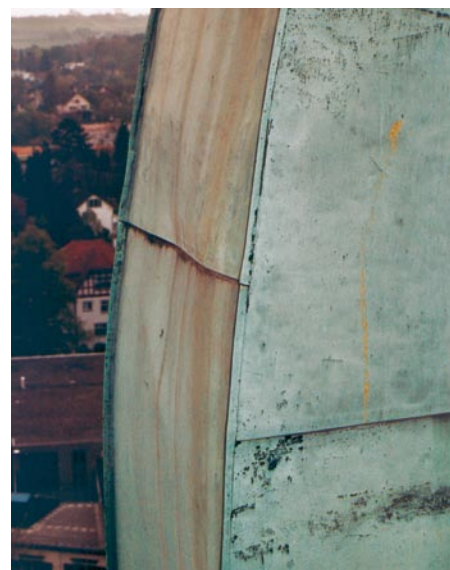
und aufgerissene Dachscharen lassen sich bei Begutachtung aus dem Hublift erkennen.
